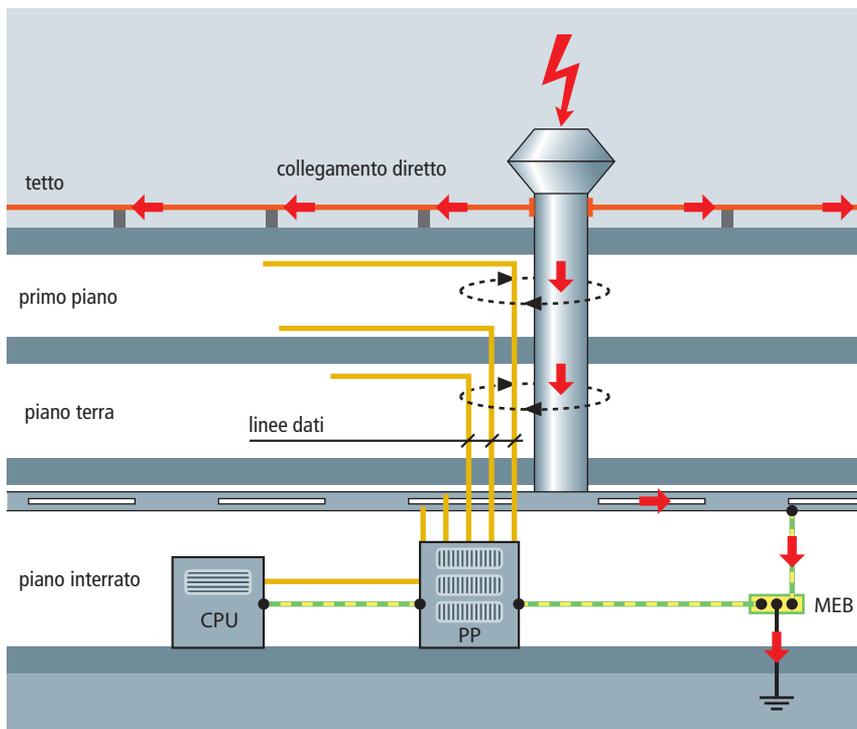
Rischio derivante dal collegamento diretto delle costruzioni sul tetto
